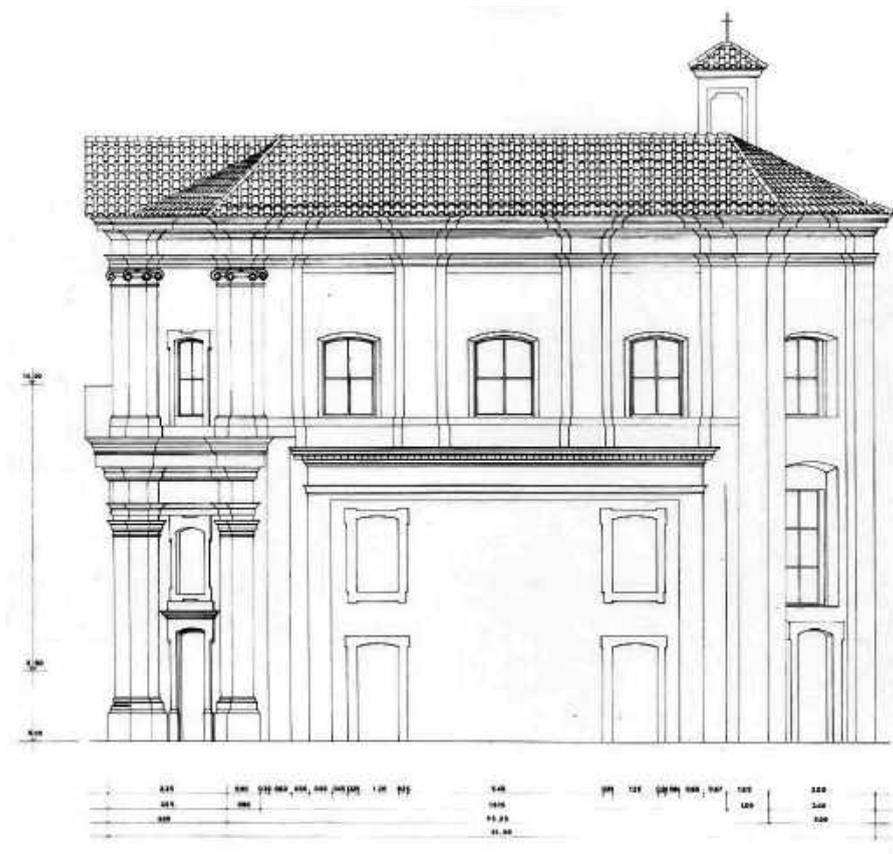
Prospetto su via San Sisto, dopo i lavori di restauro
